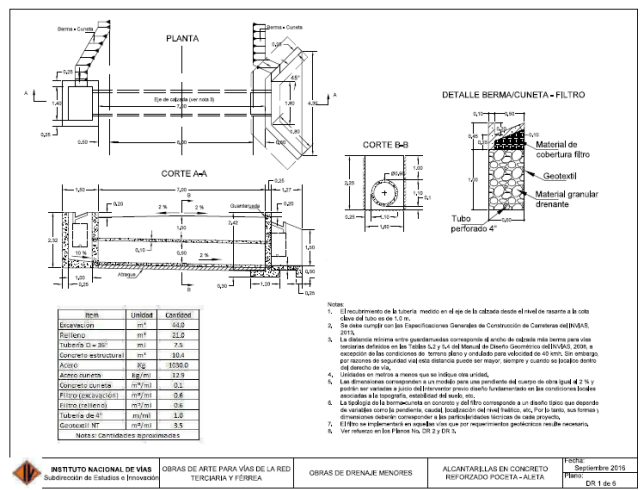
Detalle del refuerzo de alcantarilla parte 1.
